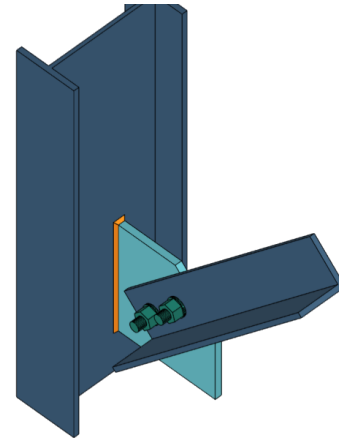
Articulation poteau-barre de contreventement en cornières par gousset sur âme
